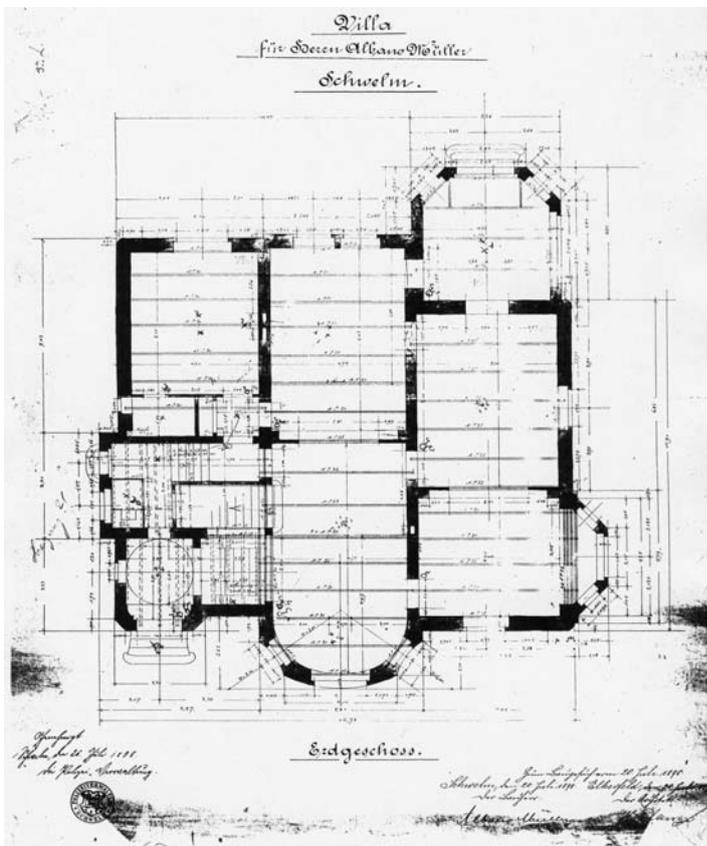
H. Plange, Villa Albano Müller, Grundriss Erdgeschoss, 1898
